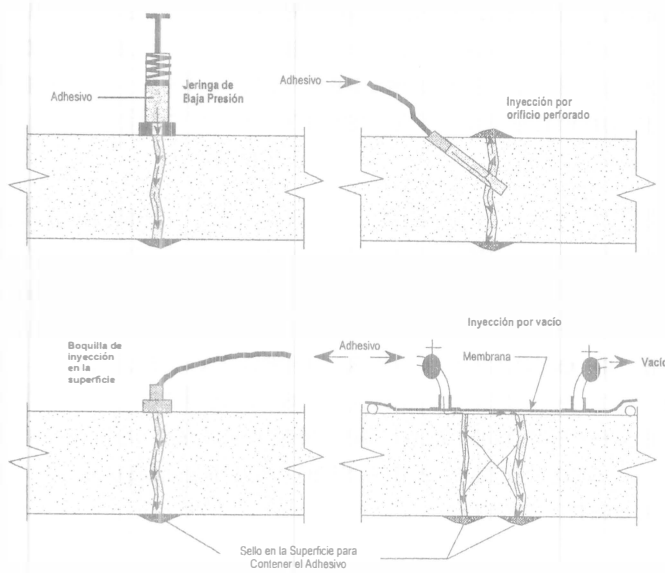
Técnicas para inyección de resinas en concreto agrietado.
